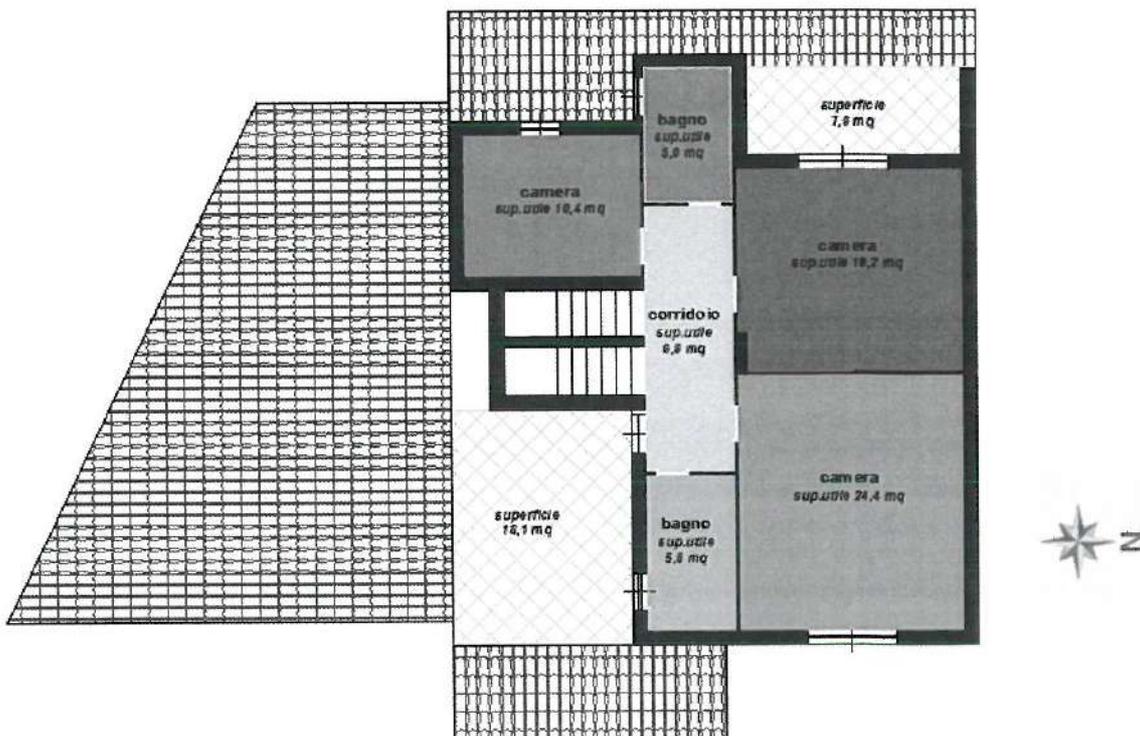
PIANTA PIANO SECONDO-STATO ATTUALE
